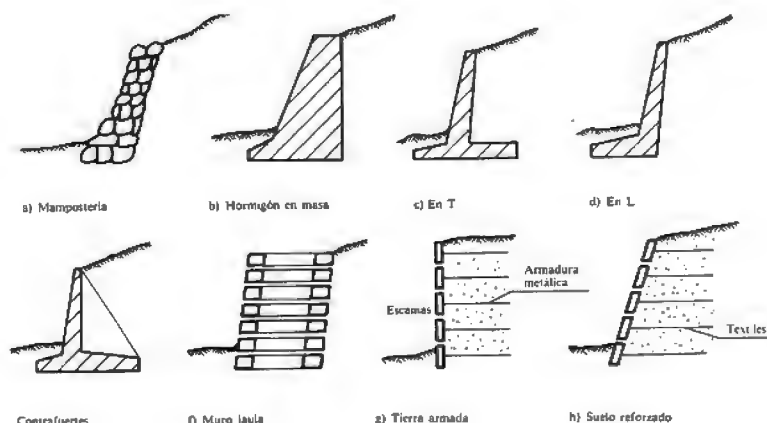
Estructuras de contención rígidas. Curso aplicado de cimentaciones J.M. Rodríguez Ortiz, J. Serra Gesta, C. Oteo Mazo, 1984.
